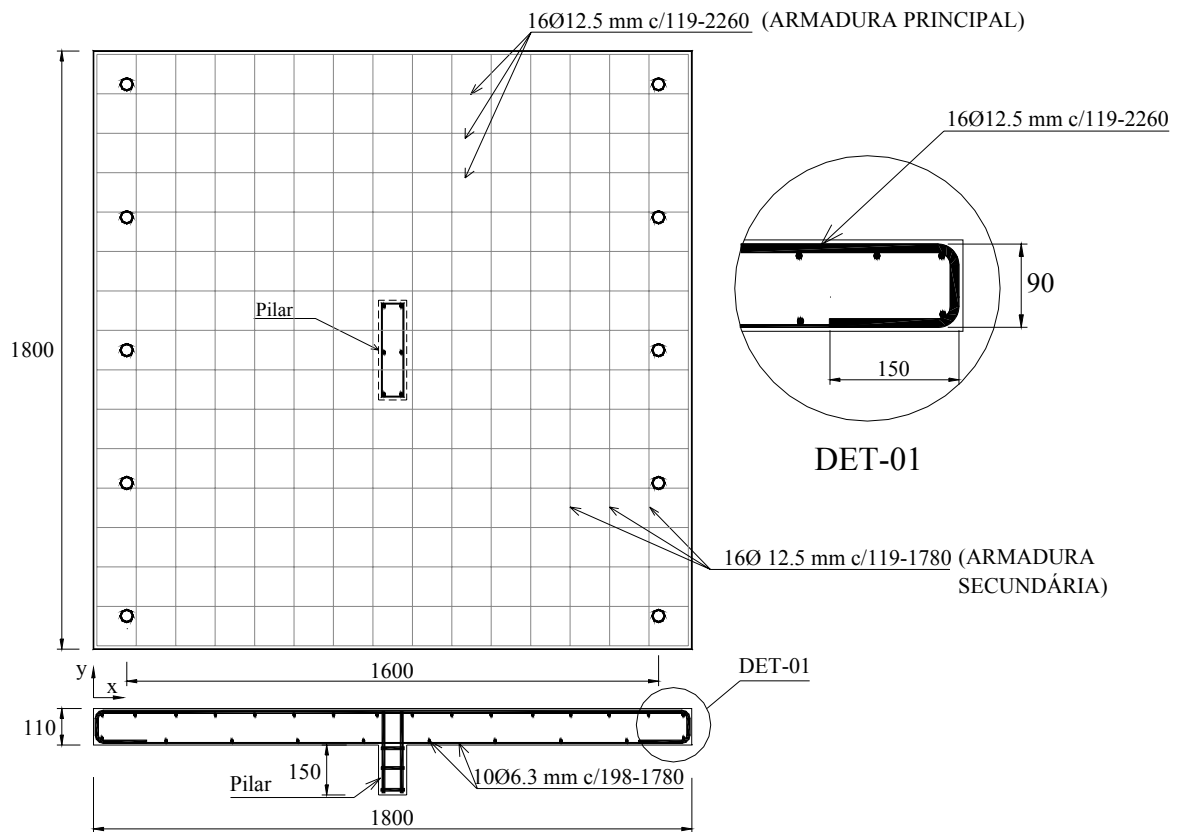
Armaduras de flexão utilizadas nas lajes L1A, L2A, L3A e L4A
